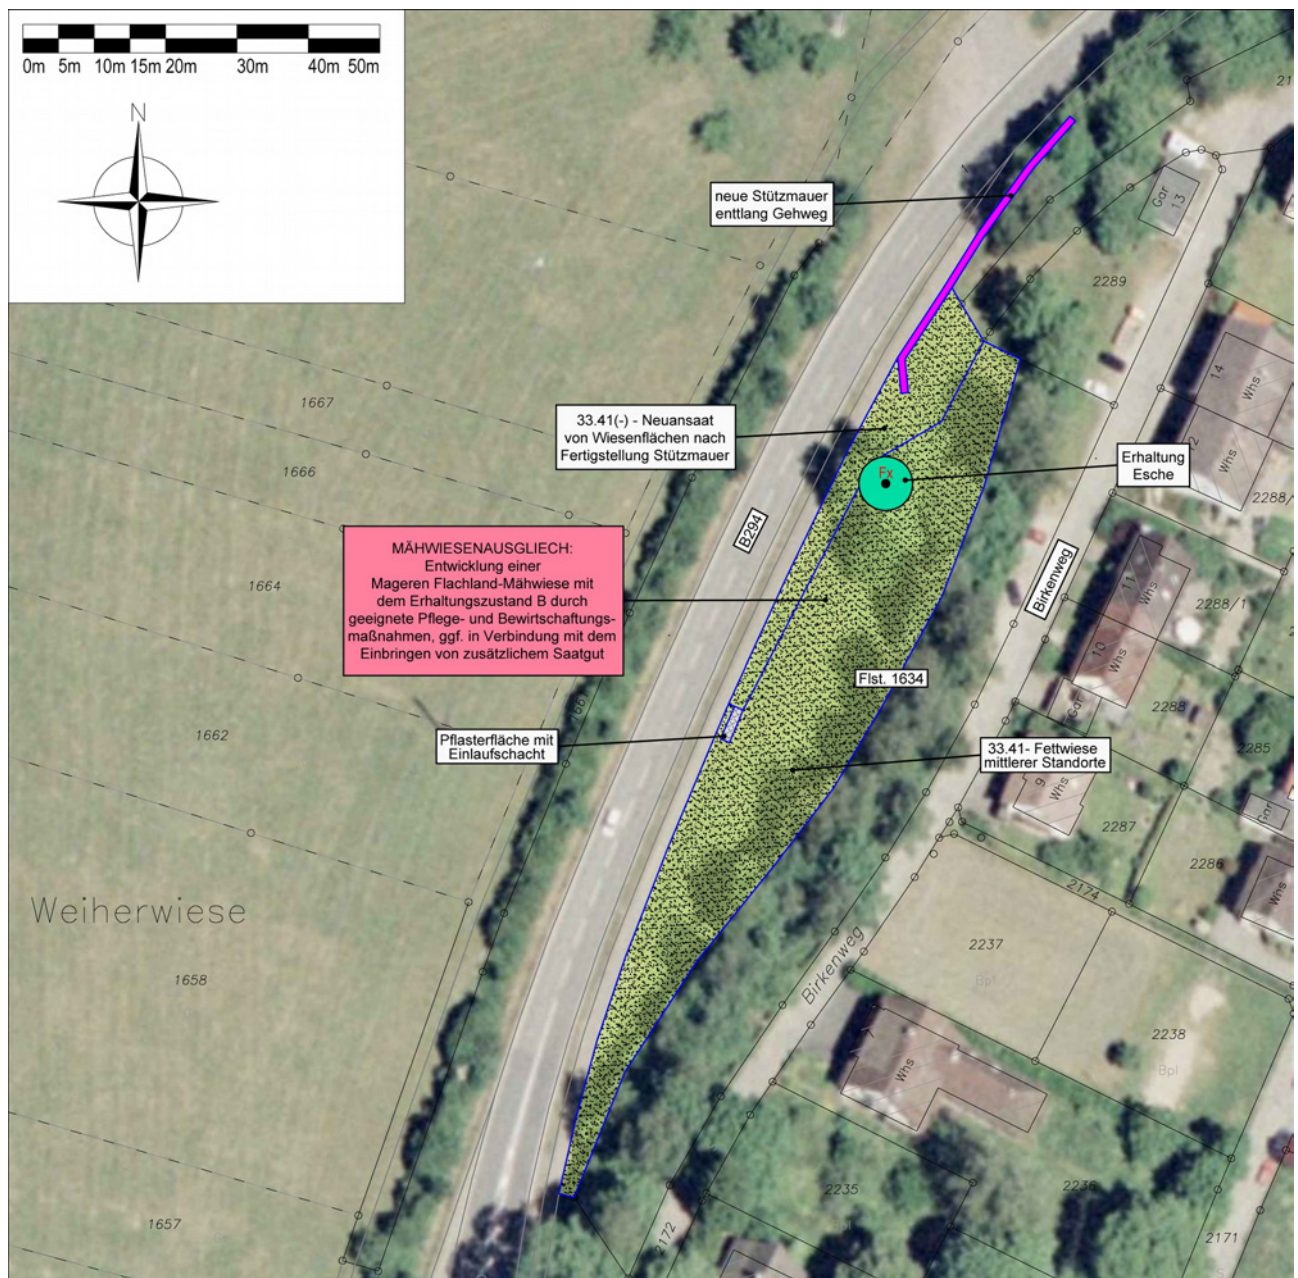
Lageplan-Ausschnitt mit Bestand auf der vorgesehenen Ausgleichsfläche
